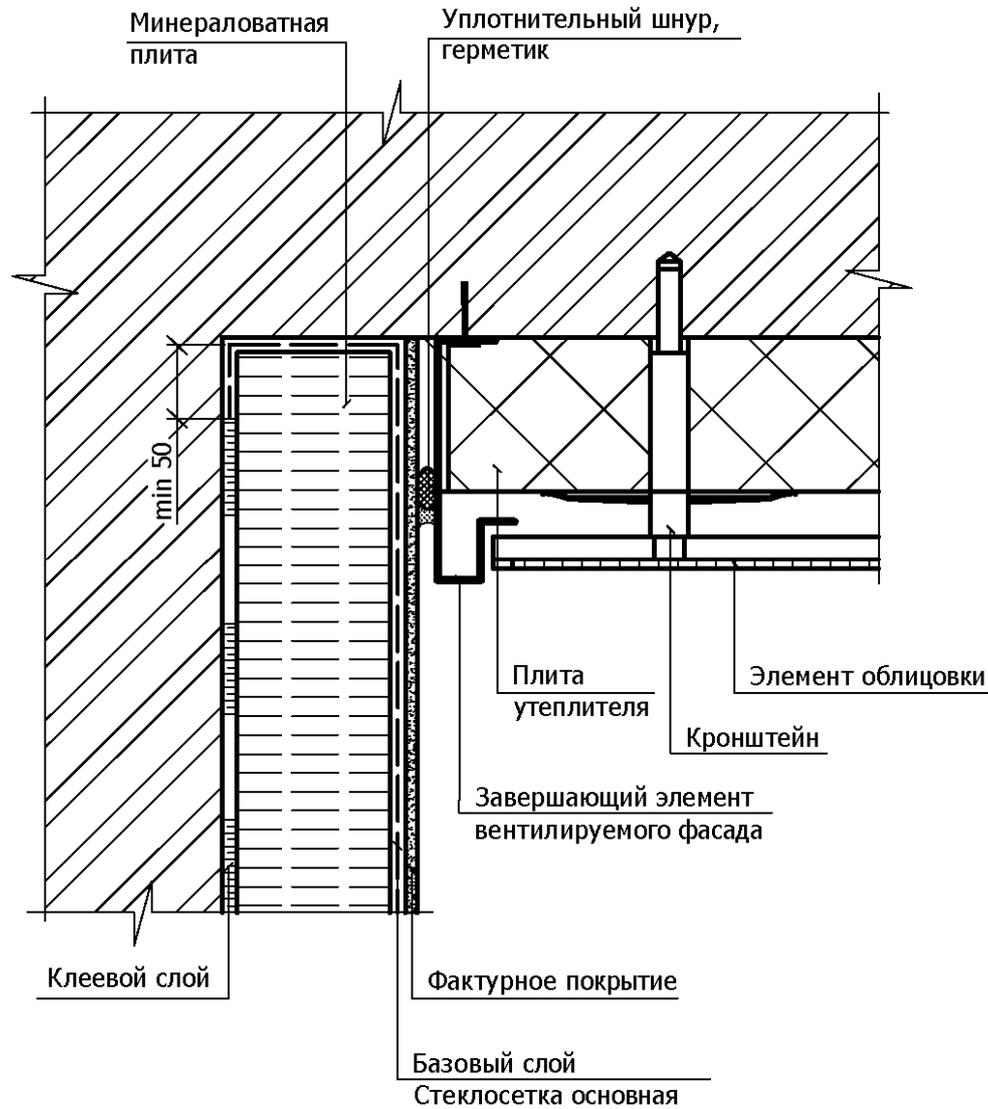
М Примыкание системы к вентилируемому фасаду на внутренних углах (вариант 1)
